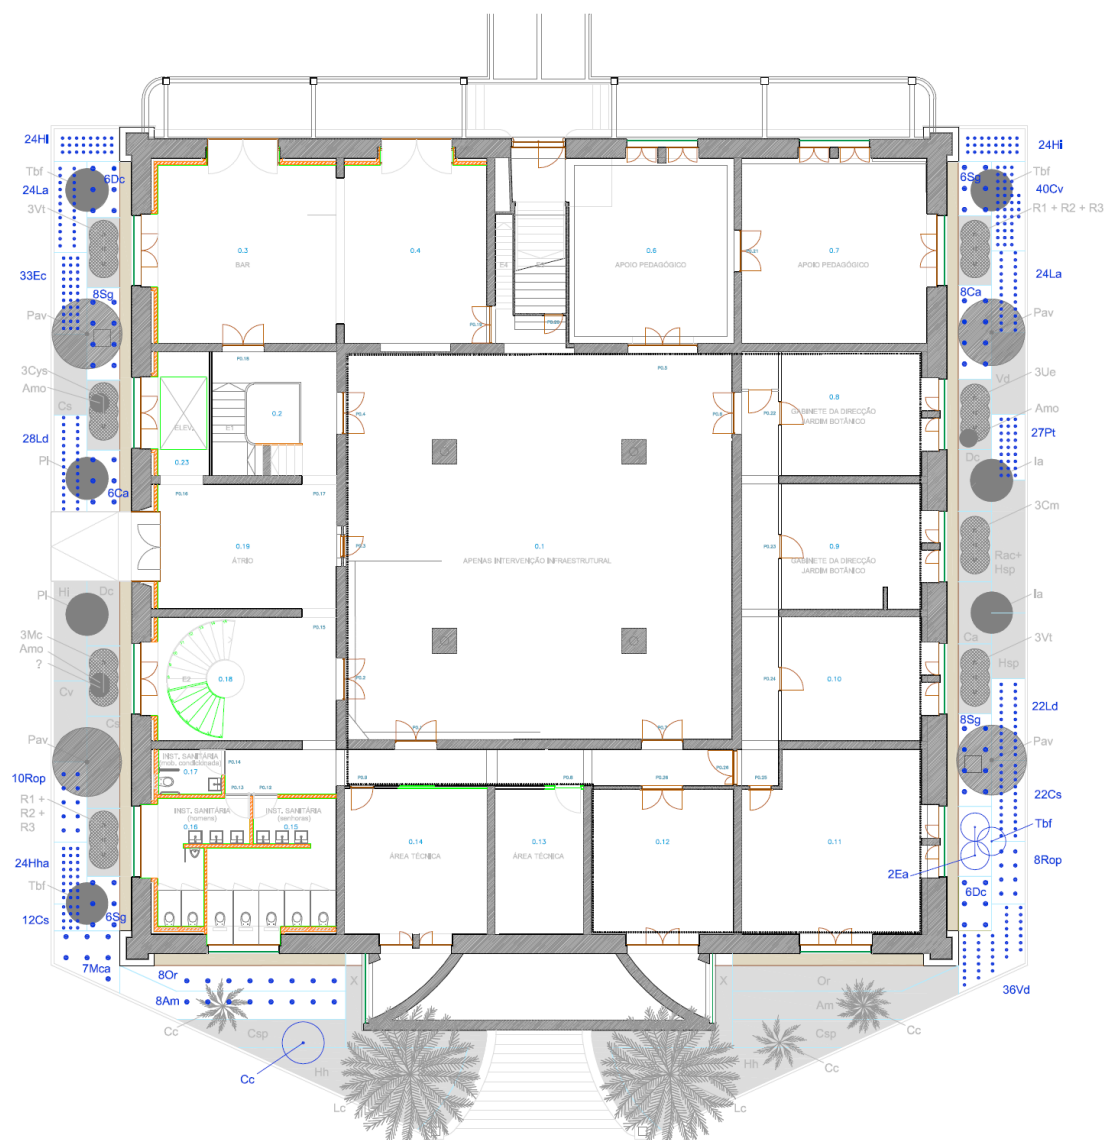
Bordadura associada à Casa Salabert - Plano de Plantação
